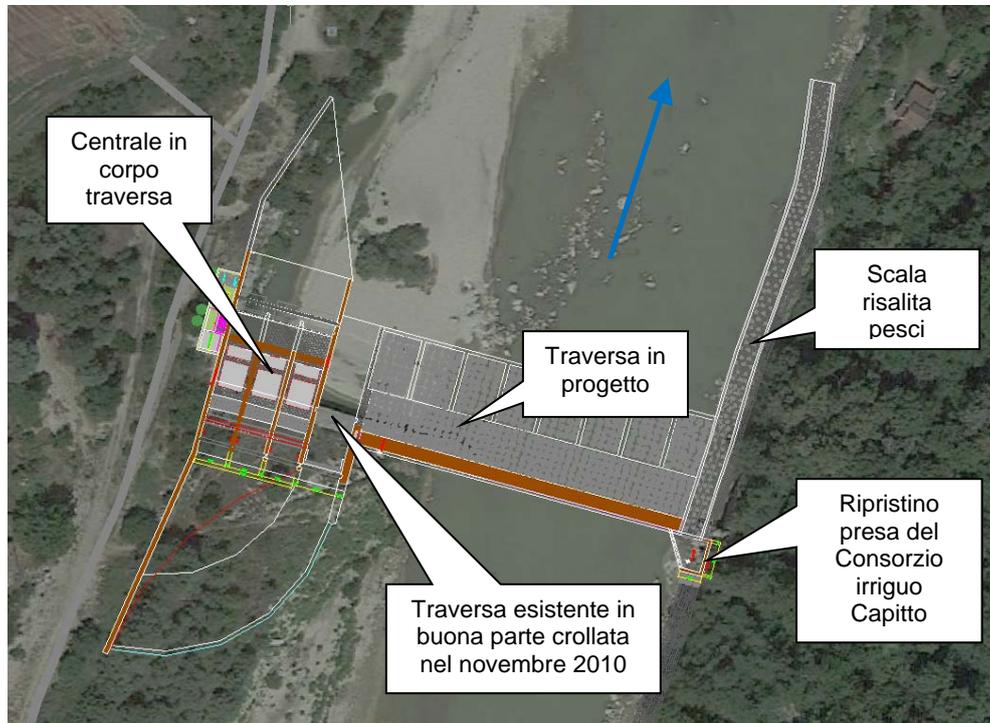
Planimetria di progetto su foto aerea (Fonte: Google Earth, 2013)
